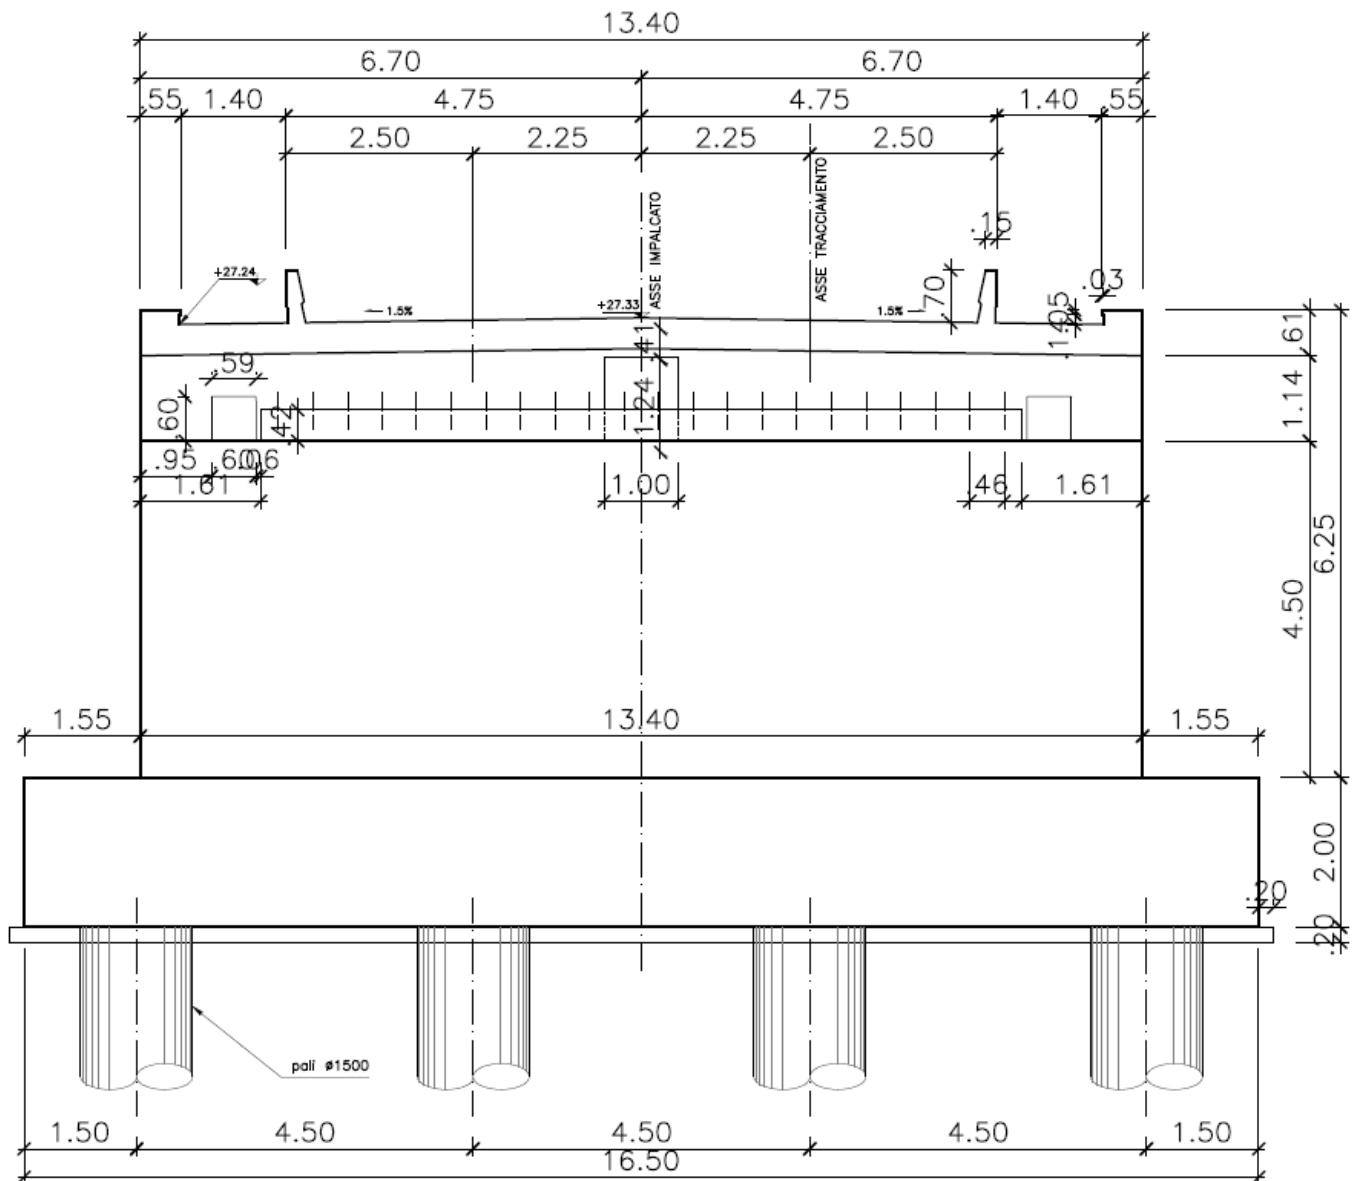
Prospetto frontale Spalla “B”.
